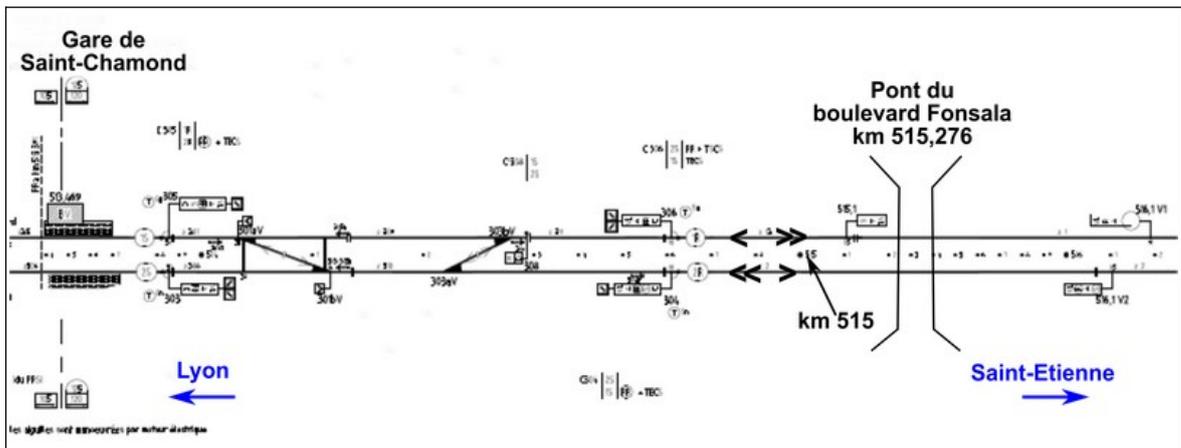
plan technique de la situation ferroviaire (source SNCF modifiée BEA-TT)
